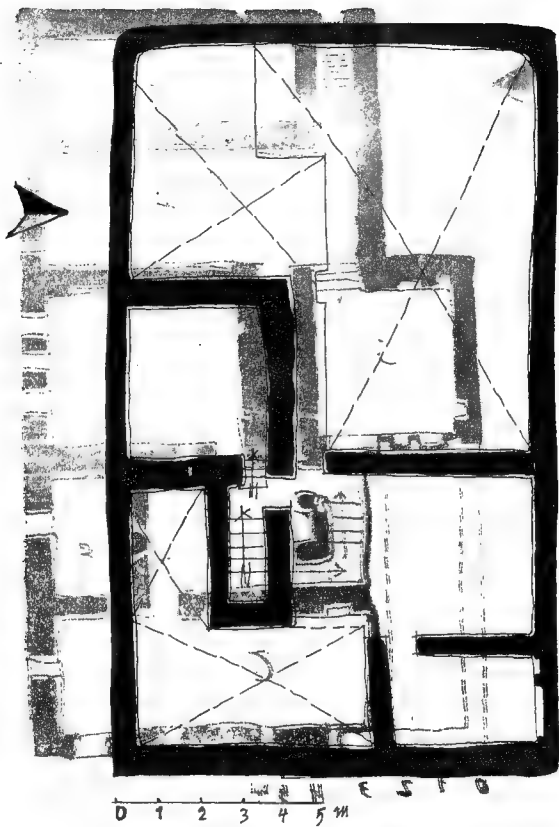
منزل مهدى عواضة الدور الأرضي - مسقط افقي
